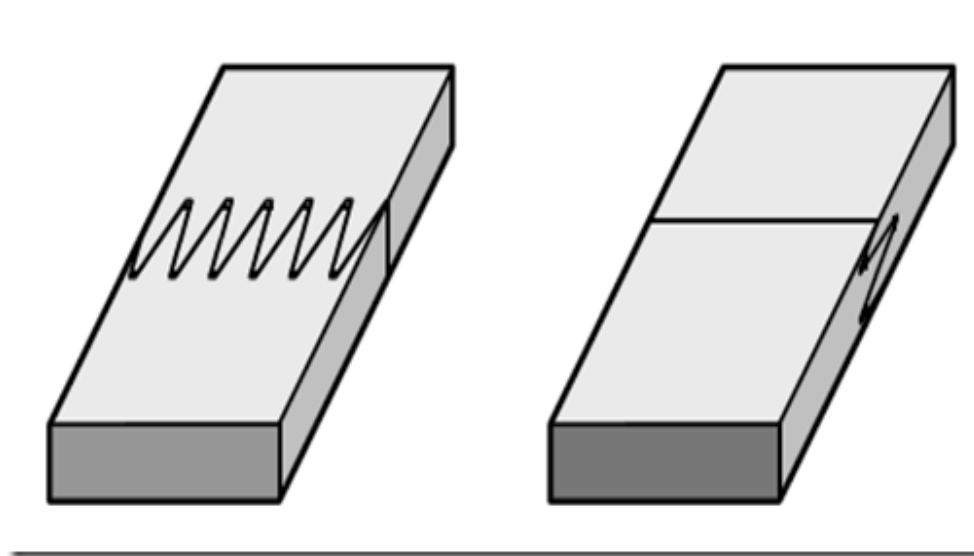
Finger-joints em Posição Transversal e Longitudinal
